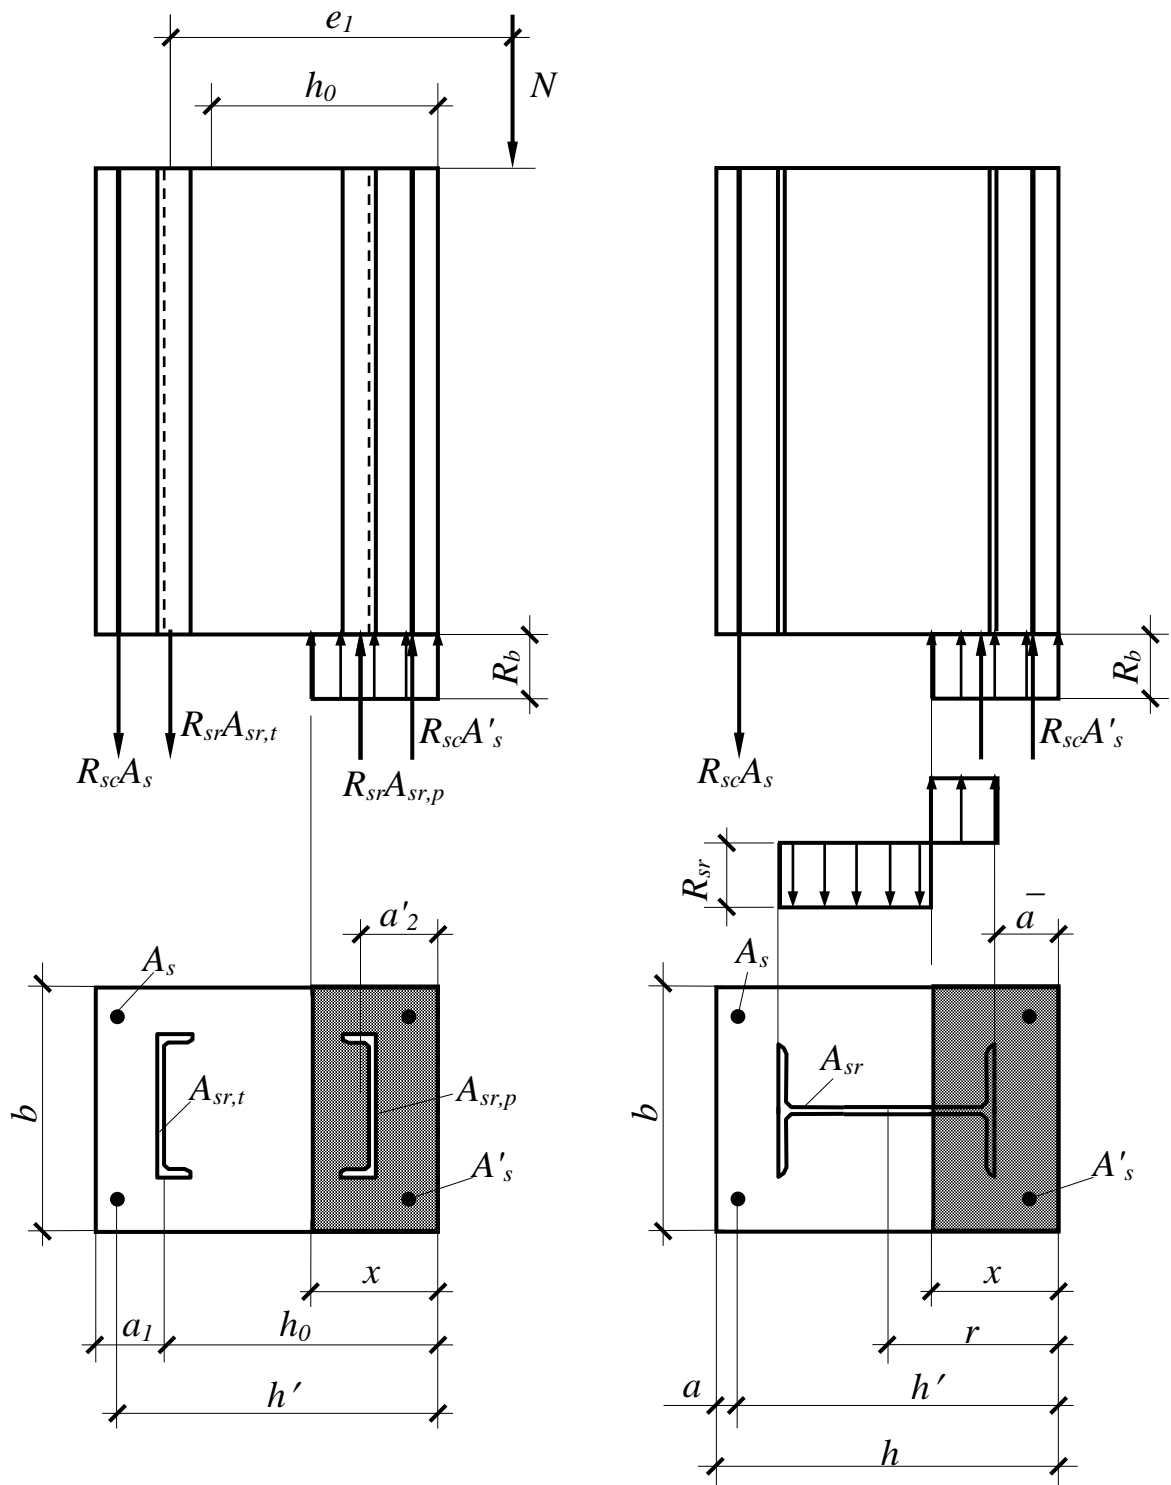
Розрахункові випадки перерізів із жорсткою арматурою
